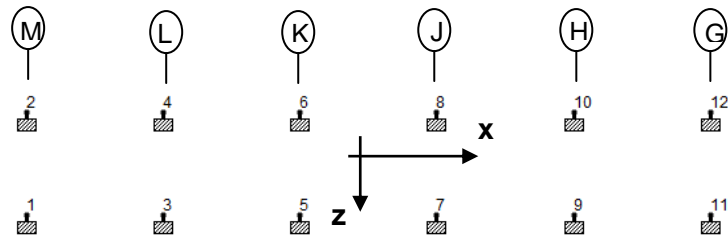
Planta de apoyos parral Este-Oeste ejes G al M
